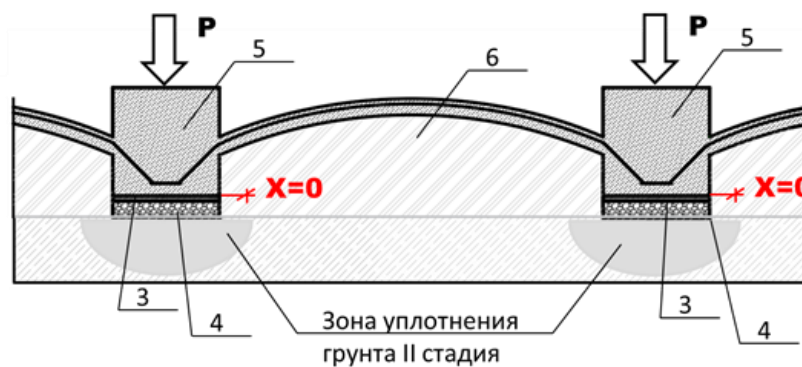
Этапы работы фундамента: II стадия, где 1 - грунтовое основание; 2 - прокладка из пенополистирола; 3 – бетонная подготовка; 4 – щебеночная подготовка; 5 - опорные железобетонные контуры; 6 – грунт подбололочной части после обжатия
